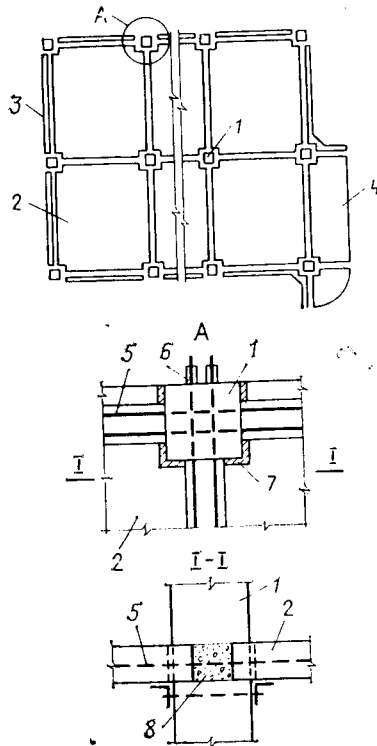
Схема несущих конструкций здания и детали узла соединения перекрытия с колонной
